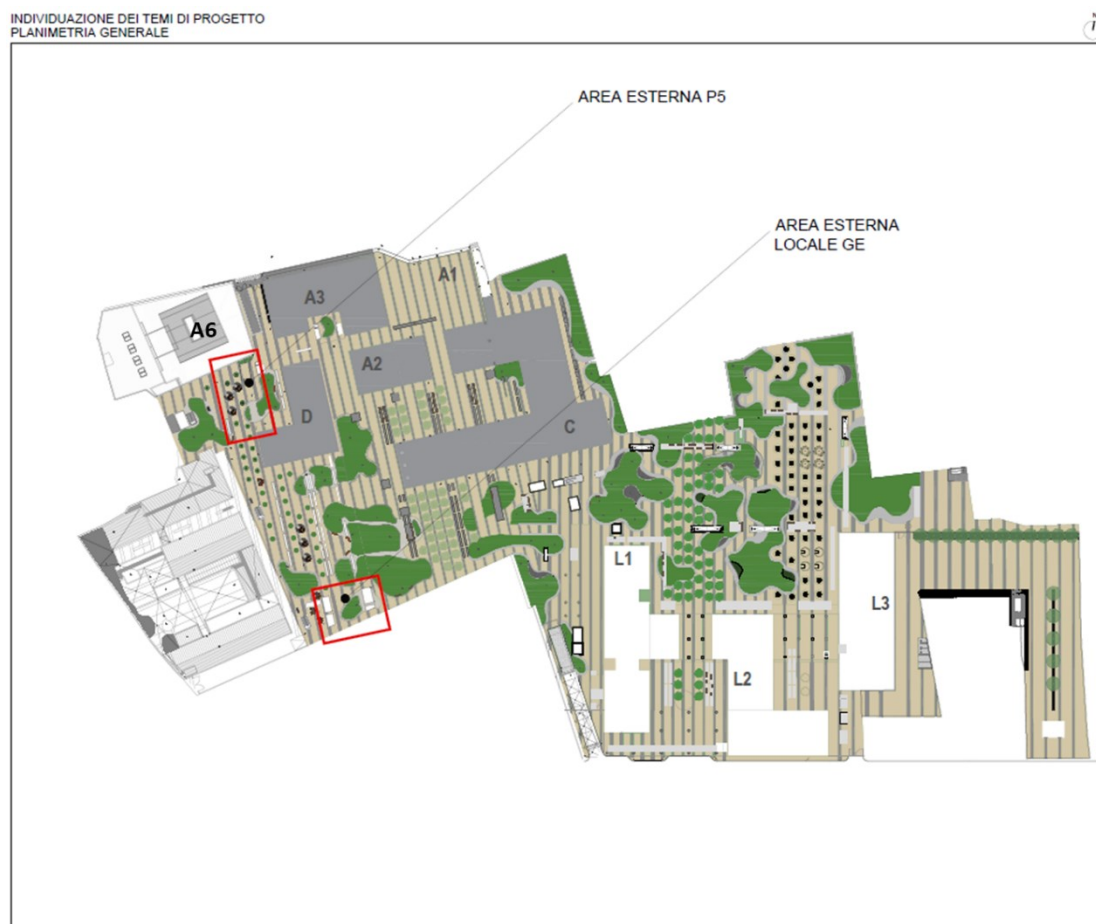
, Planimetria Generale Università ed evidenza delle aree di intervento
